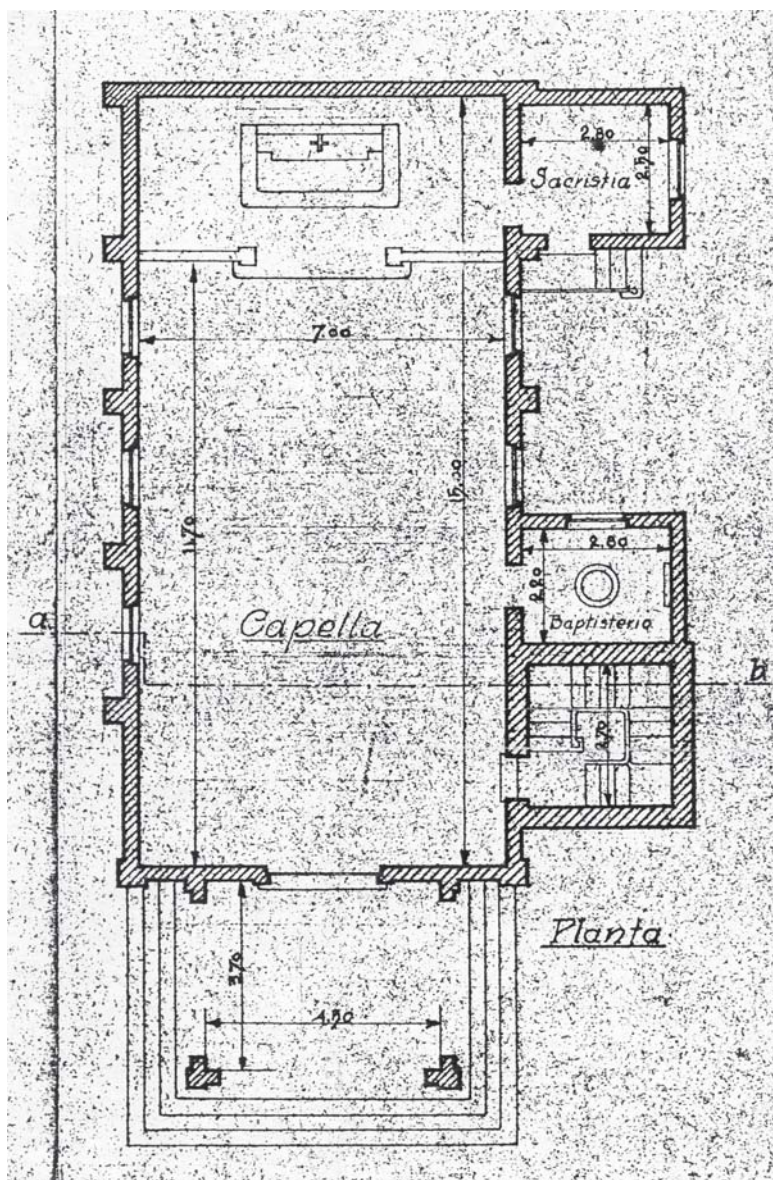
Planta da capela Santa Rita de Cássia, da fazenda São Roberto, Ibaté. Acervo da fazenda São Roberto.
